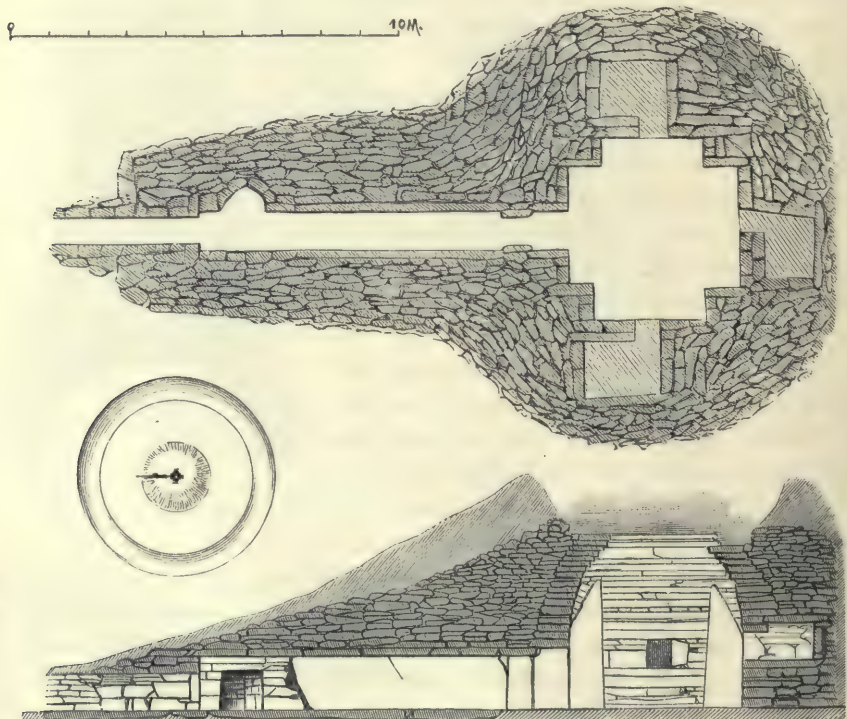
b. Grundriss des Maeshowe (Fig. 127 a). — c. Grundriss des Grabes in dem Hügel. — d. Längsdurchschnitt der Kammer und des Ganges.
